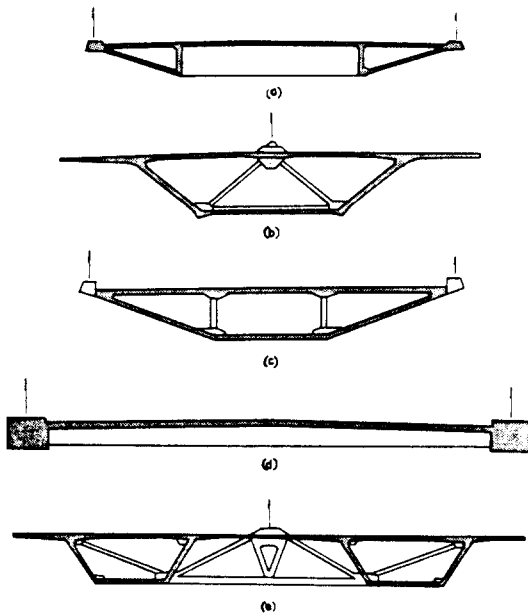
콘크리트 상부구조 단면에 : (a) Pasco-Kennewick Bridge, Washington, (b) Sunshine Skyway Bridge, Florida, (c) Neches River Bridge, Texas, (d) Dame Point Bridge, Florida, (e) James River Bridge, Virginia and proposed Cooper River Bridge, South Carolina.
